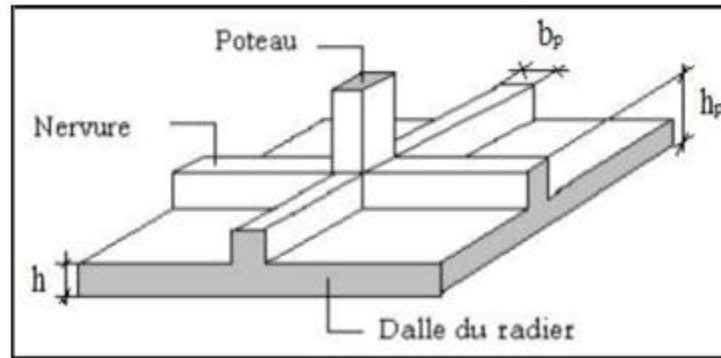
Disposition des nervures par rapport au radier et aux poteaux
